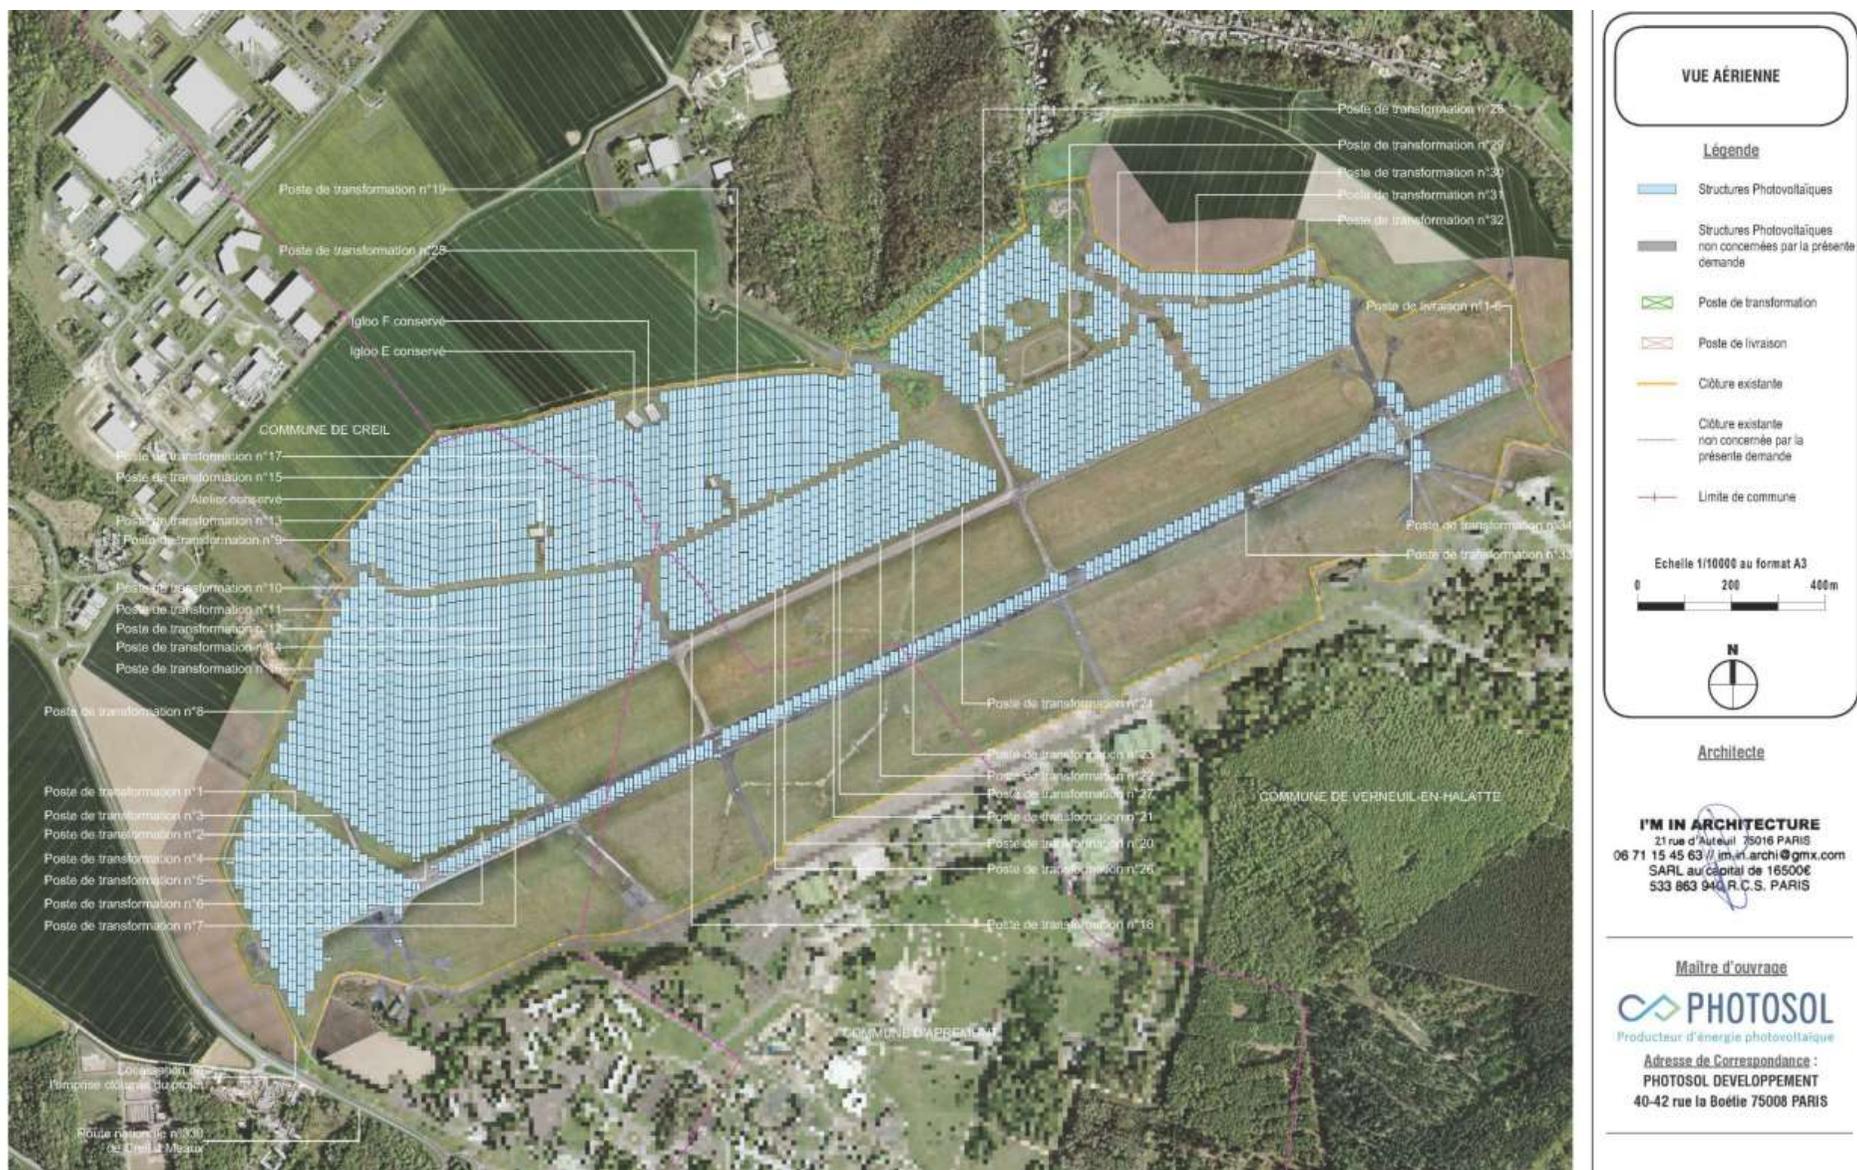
Plan de masse de l'installation (source : PHOTOSOL)
